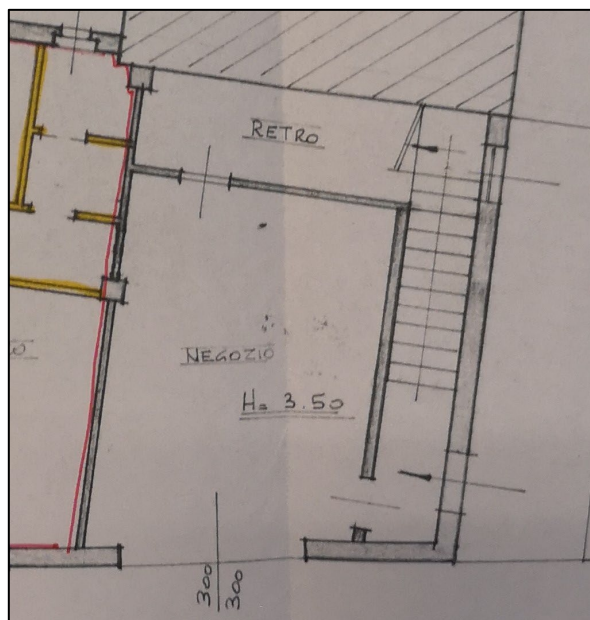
Planimetria allegata L.E. n. 11/75 del 9.06.1975
